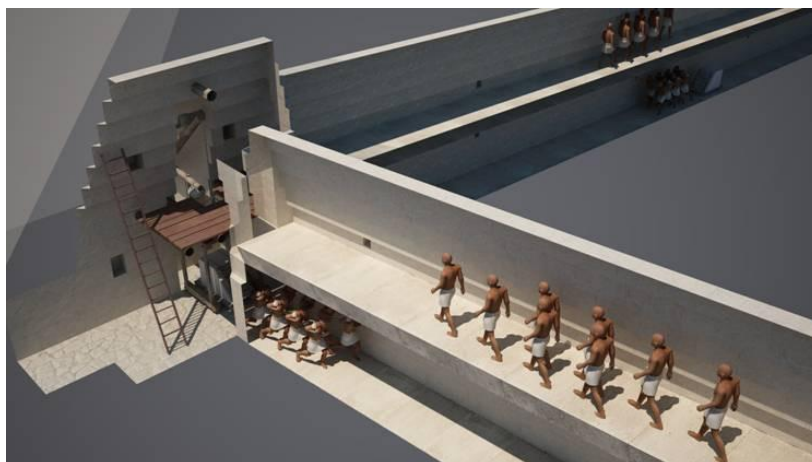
Configuration de la rampe intérieure modélisée en 3D (Houdin J-P, Dassault Systèmes)
